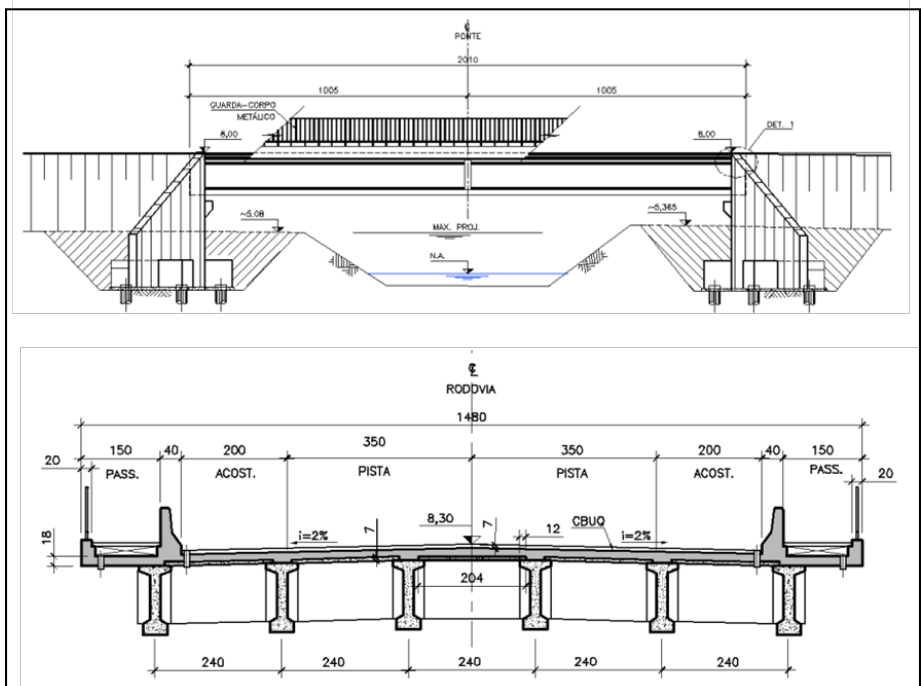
Vista lateral da Obra de Arte Especial (OAE) e seção transversal da superestrutura
